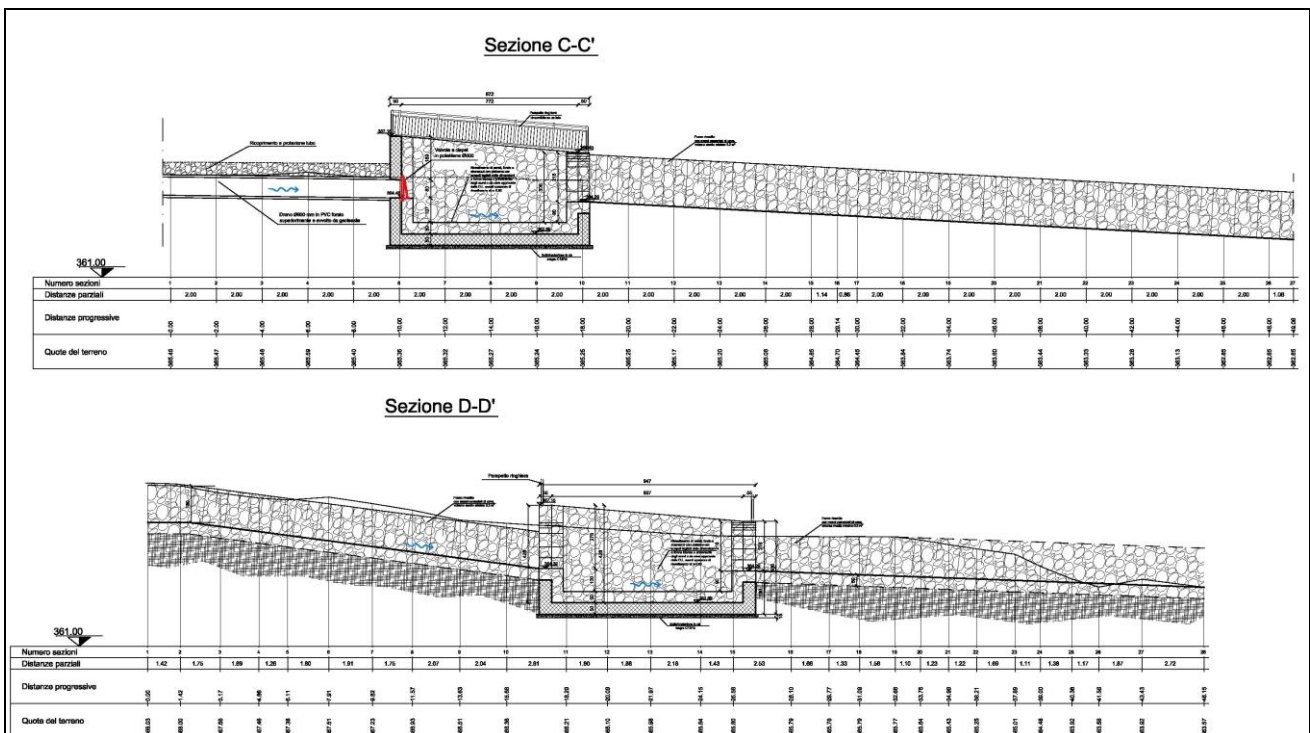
Compluvio nord – Vasca di sedimentazione - sezione
